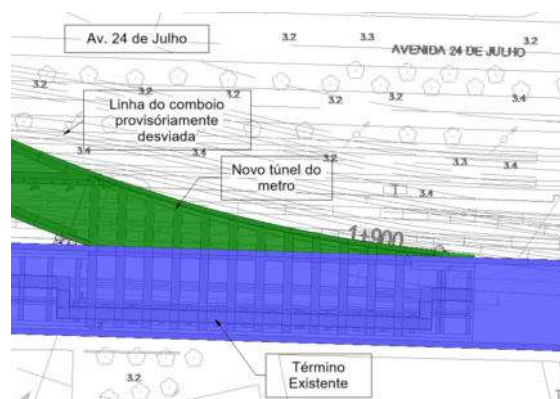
Planta de Implantação do Novo Túnel e da Estrutura do Terminal Existente
